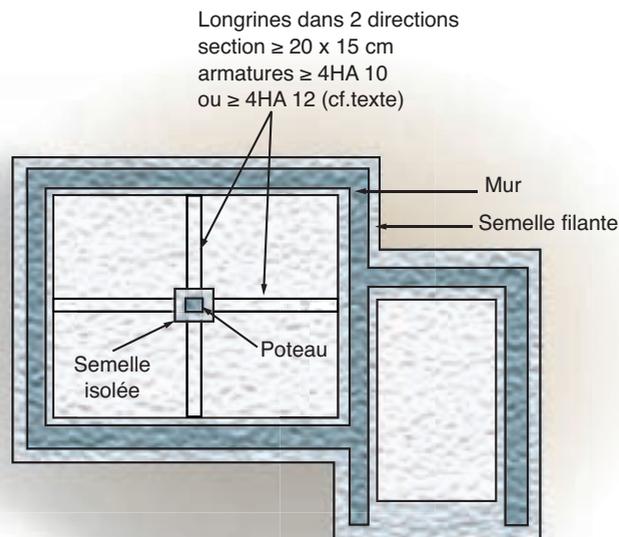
Semelle isolée sous poteau. Les semelles isolées doivent être reliées entre elles et aux semelles filantes dans deux directions perpendiculaires
